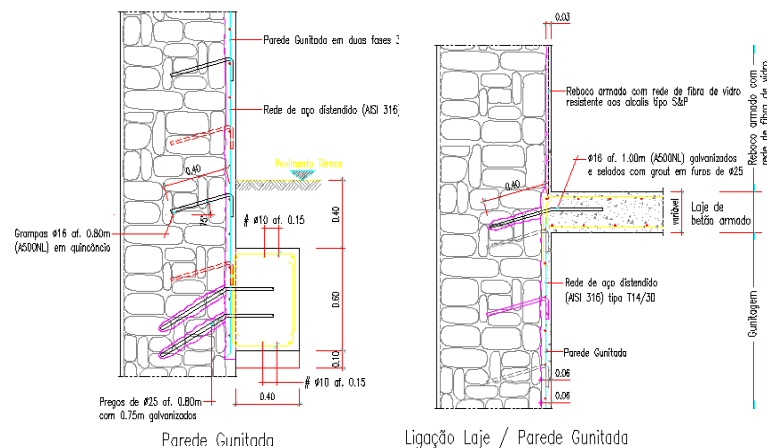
Ligaçãõ da parede gunitada ao lintel de fundaçãõ e ligaçãõ da laje à parede gunitada
